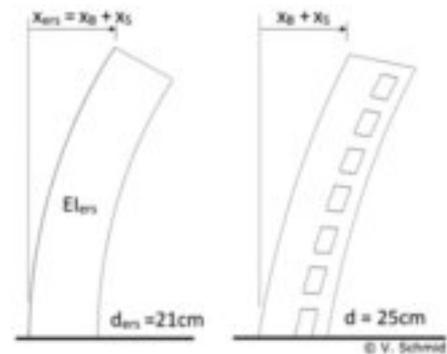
Ersatzwanddicke d_{ers} für eine Stahlbetonwand
